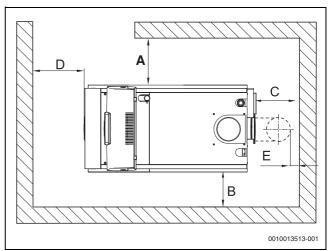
Distanze dalle pareti nel locale di posa (versione sinistra)
